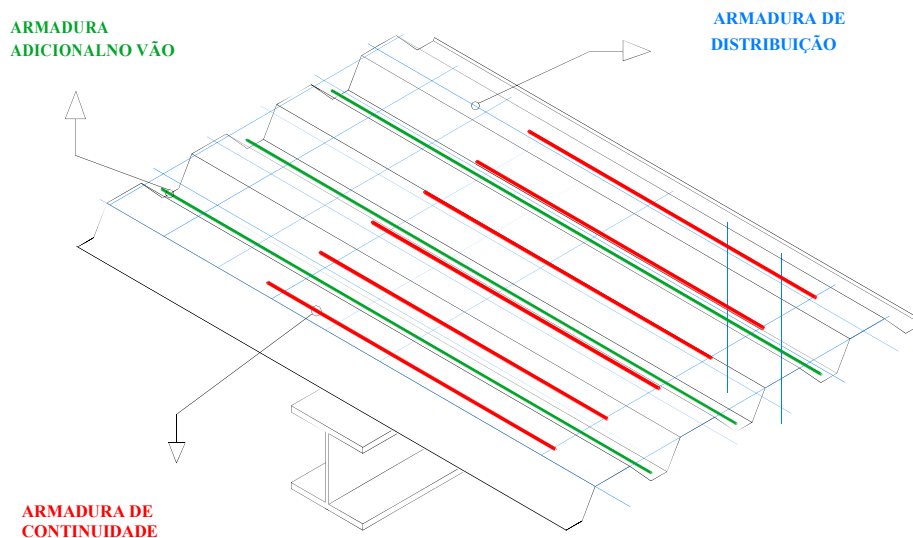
Disposição esquemática das armaduras em lajes mistas
